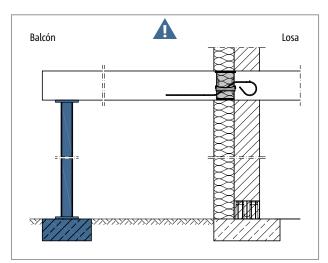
Schöck Isokorb® XT tipo Q-Z-V5 hasta Q-Z-V11, Q-V5 hasta Q-V11: Sección A-A; losa de hormigón armado tensada sobre un eje
